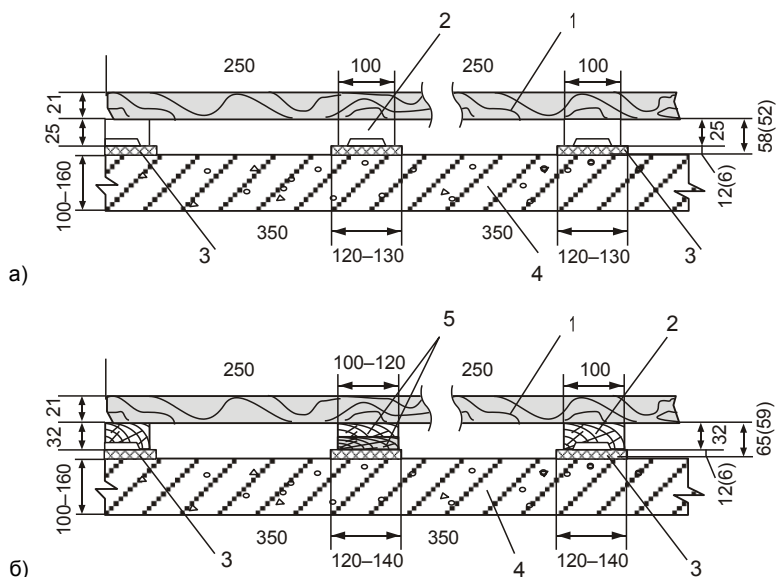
Конструктивные схемы междуэтажных перекрытий в жилых зданиях:
